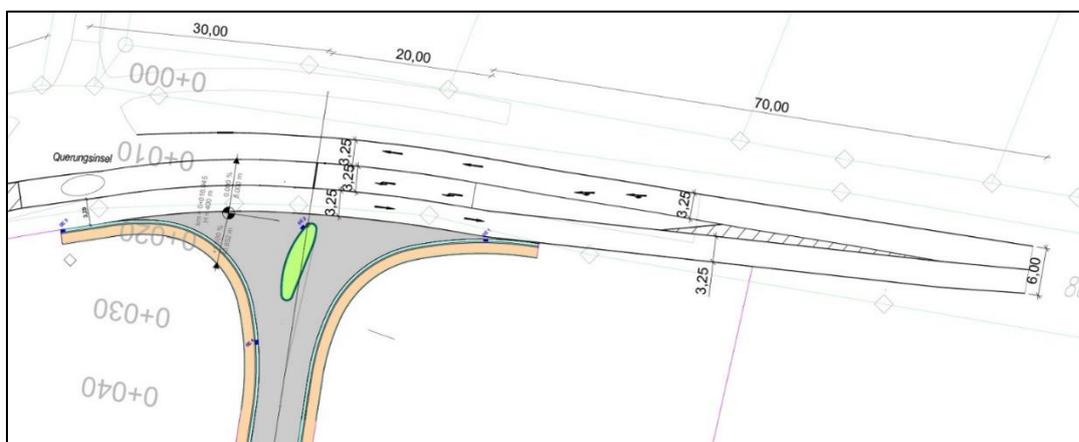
Geometrie der Verkehrsanlage mit Einmündungsbereich, Quelle: elementar Ingenieurbüro GmbH, Goldbach, 06/2020
